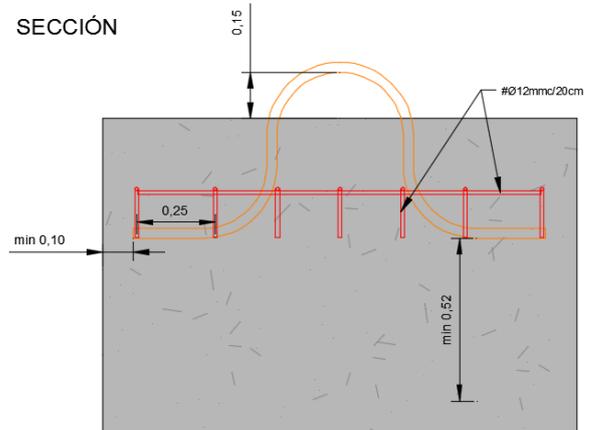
Detalle de arganeo y armado de enganche de muerto de amarre
